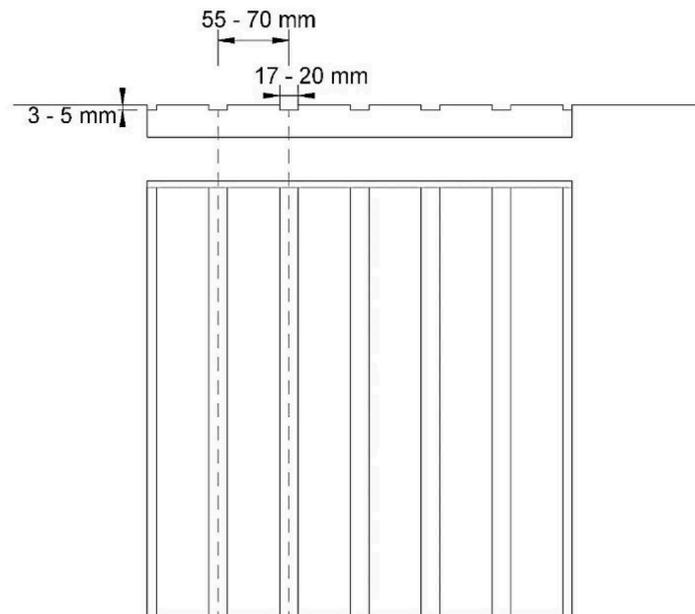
2. Gráfico con las dimensiones del pavimento de estrías en bajorrelieve
